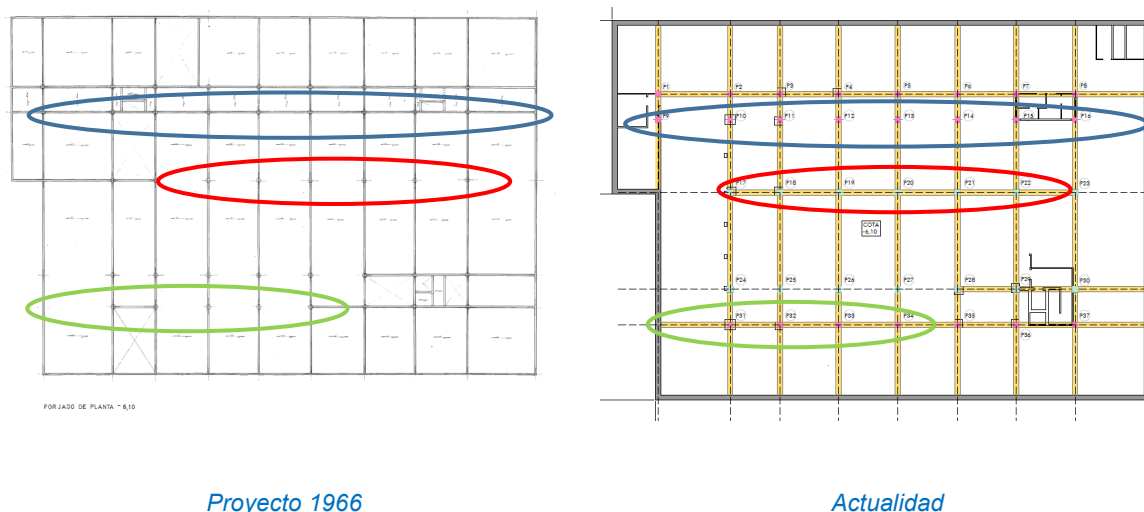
Diferencias en la planta sótano -2 (-6.10) entre la situación recogida en el proyecto de 1966 y la actualidad
